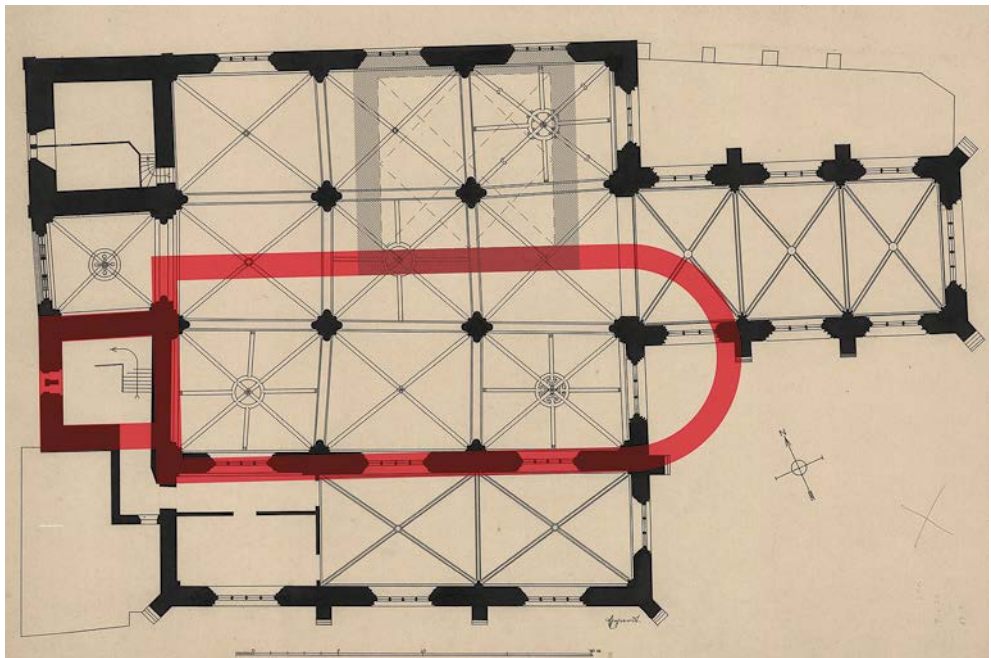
Unser Lieben Frauen, Grundriss Bau II um 1013/1029
